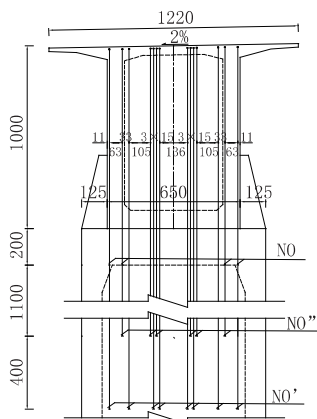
墩梁固结竖向预应力布置横断面图(单位:cm)
